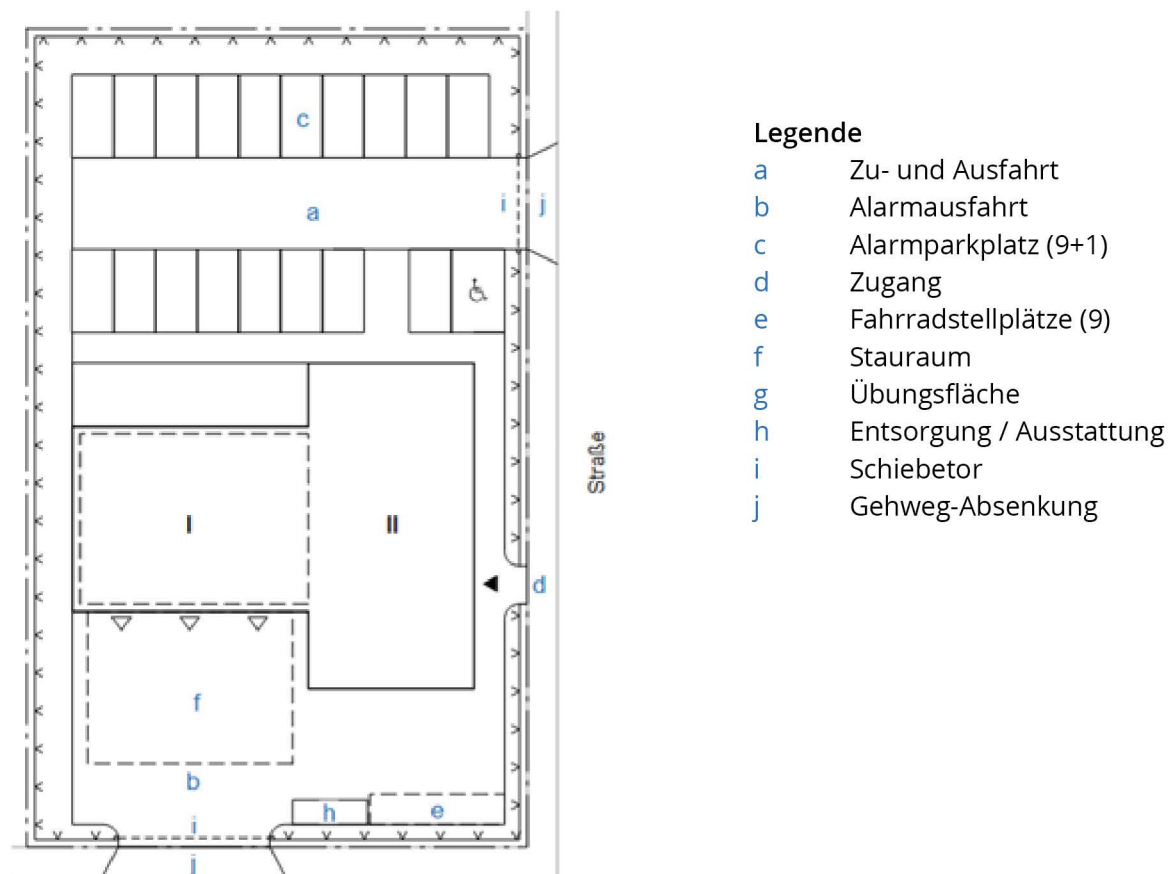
BB 3 eingeschossig – Lageplan, Alarmparkplätze rückwärts (oben) und seitwärts (rechts) vom Gebäude
